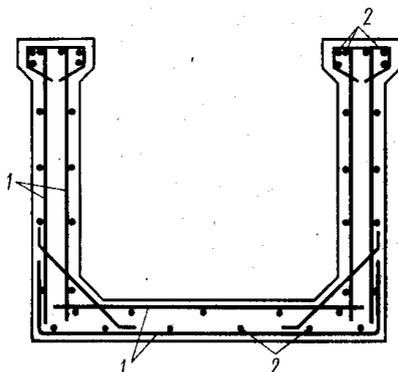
Размещение арматуры в поперечном сечении лотка акведука: 1 – рабочая арматура в поперечном направлении; 2 – то же, в продольном
